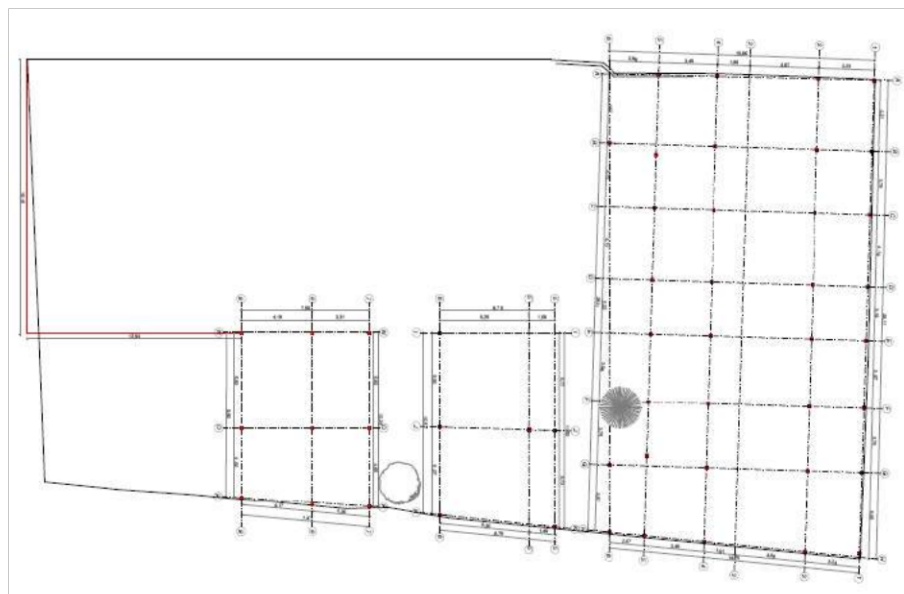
Eje estructural de los bloques 2 y 3. // Fuente: (Surrealestudio, 2021).
